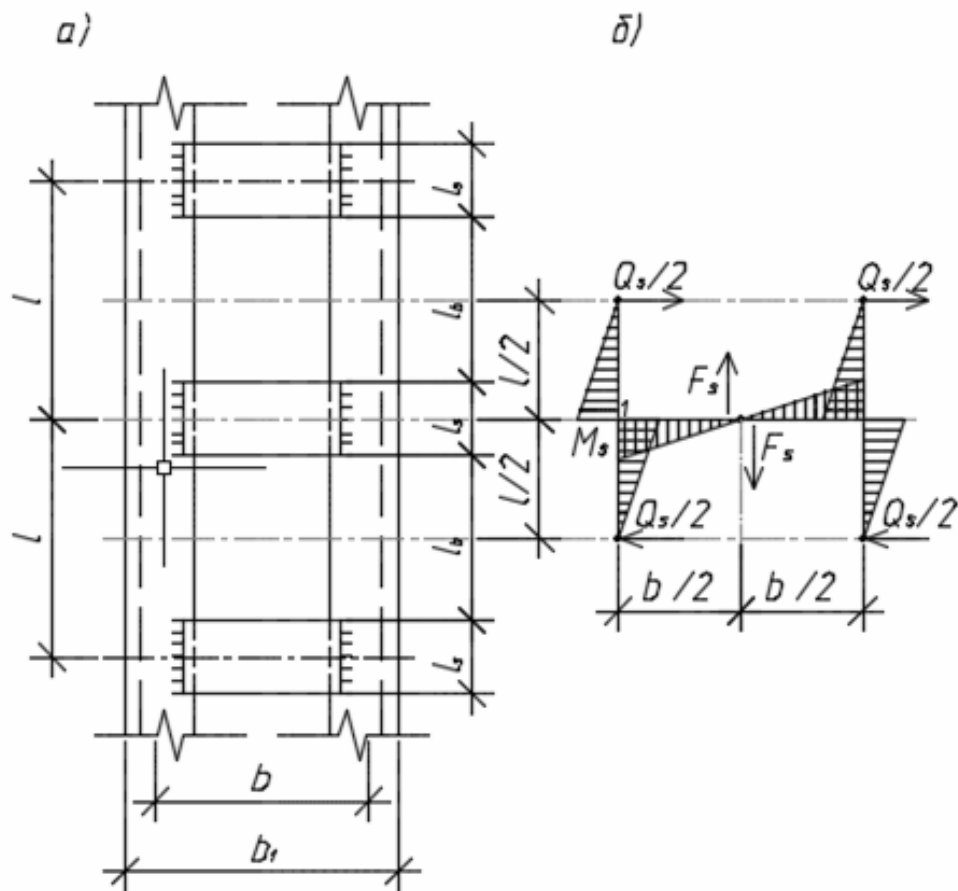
До розрахунку сталевих планок колон [2]: *a* – схема решітки на планках; *b* – розрахункова схема
